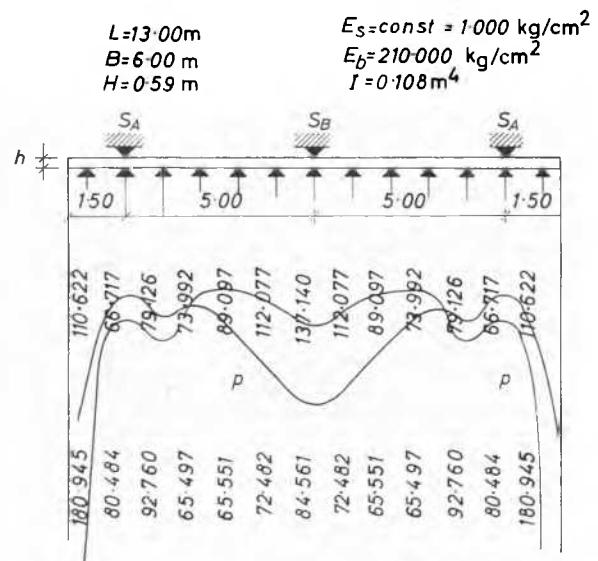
Poutre continue 1·5+5·0+5·0+1·5
